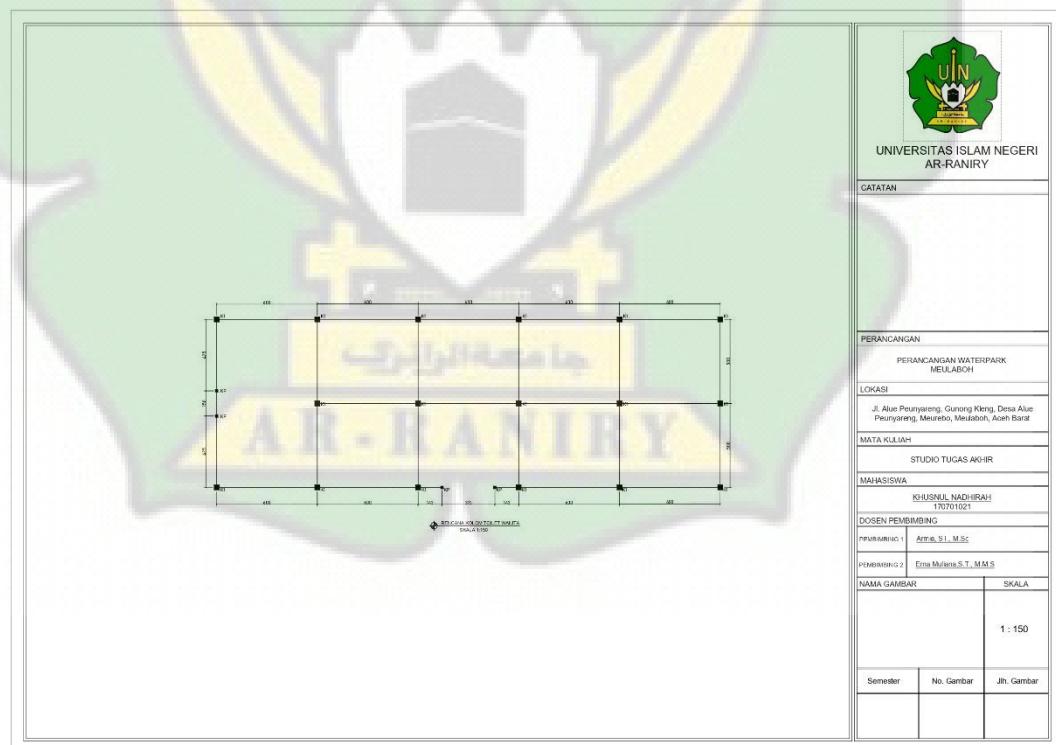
Detail Rencana Kolom Balancing Tank Dan Ruang Genset
